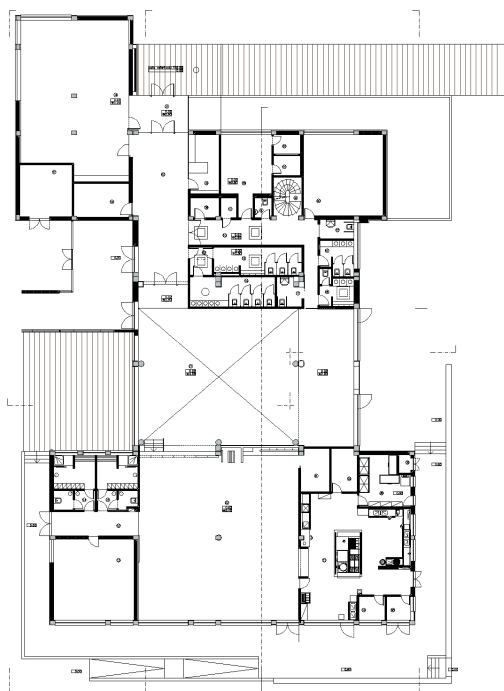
Planta do Piso 1 do Bloco A. [33]
